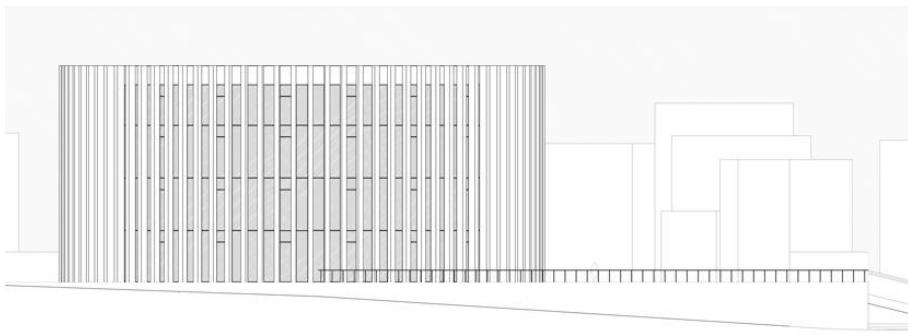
Alçado poente (Rua da Trindade)
